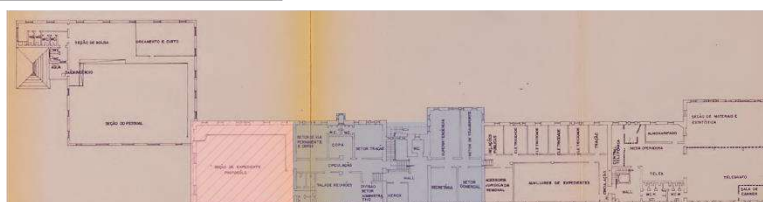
Planta do segundo edifício da estação: destaque da segunda fase construtiva.
